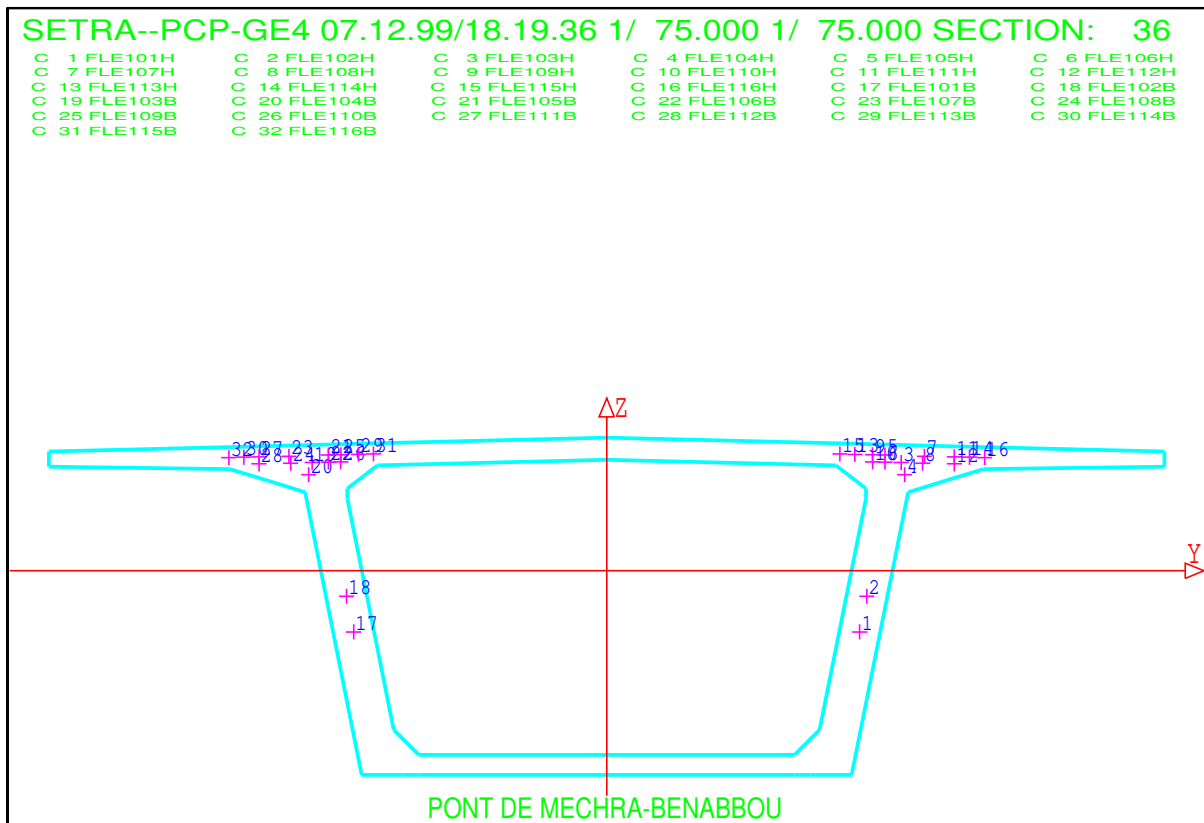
Poutre spatiale, coupe transversale, coffrage, câblage
